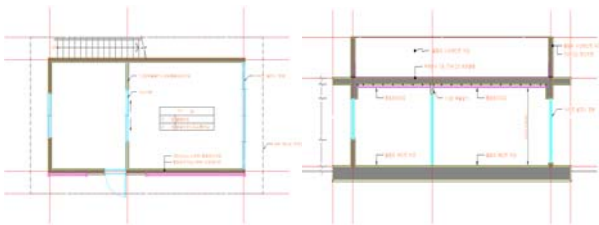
바닥충격음 실험동의 평면도 및 단면도
